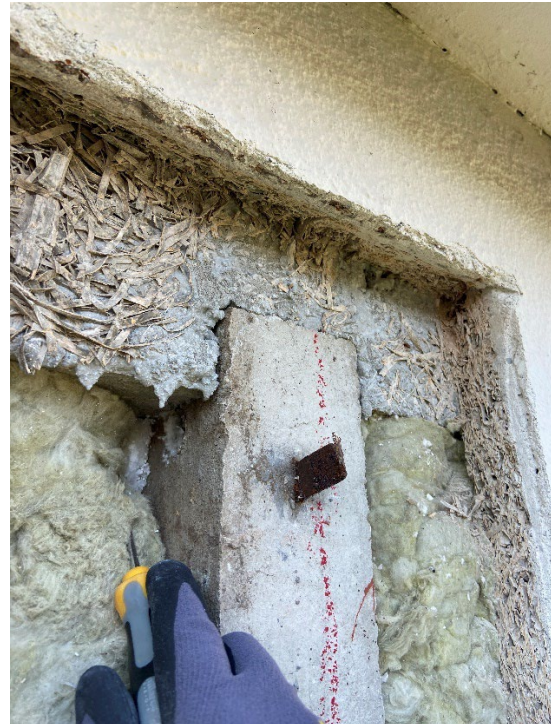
Facade. Samling betonsøjle og betonbjælke. Vederlaget synes intakt. Der kan registreres en mindre vandretliggende revne over det indstøbte montagejern.
